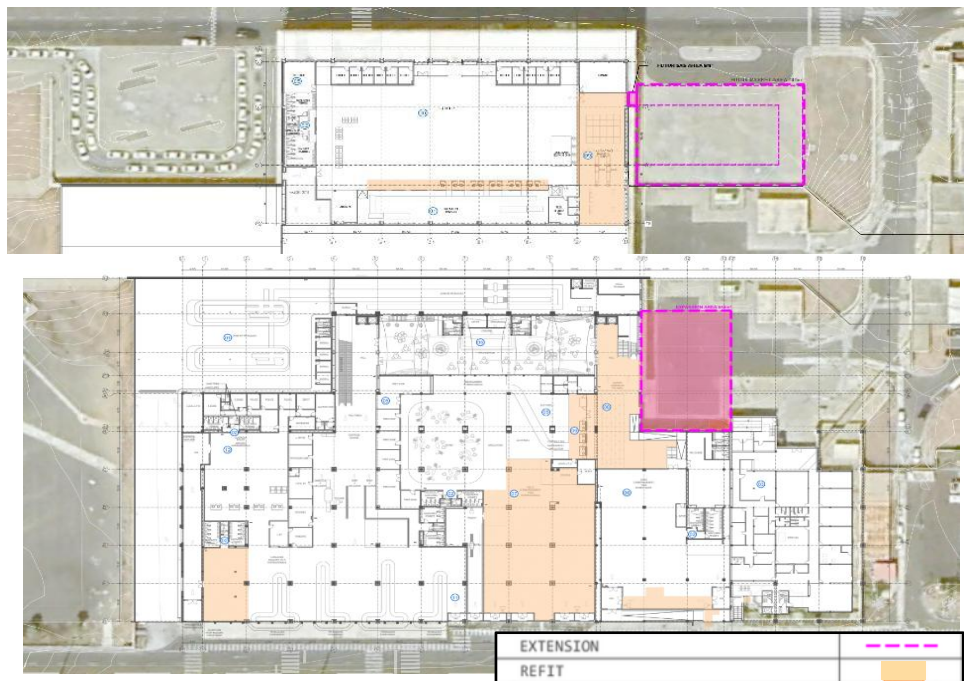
| Planta Sumária de Intervenções no piso 1 e piso 0 do Terminal RAI: Extensão e Refit
